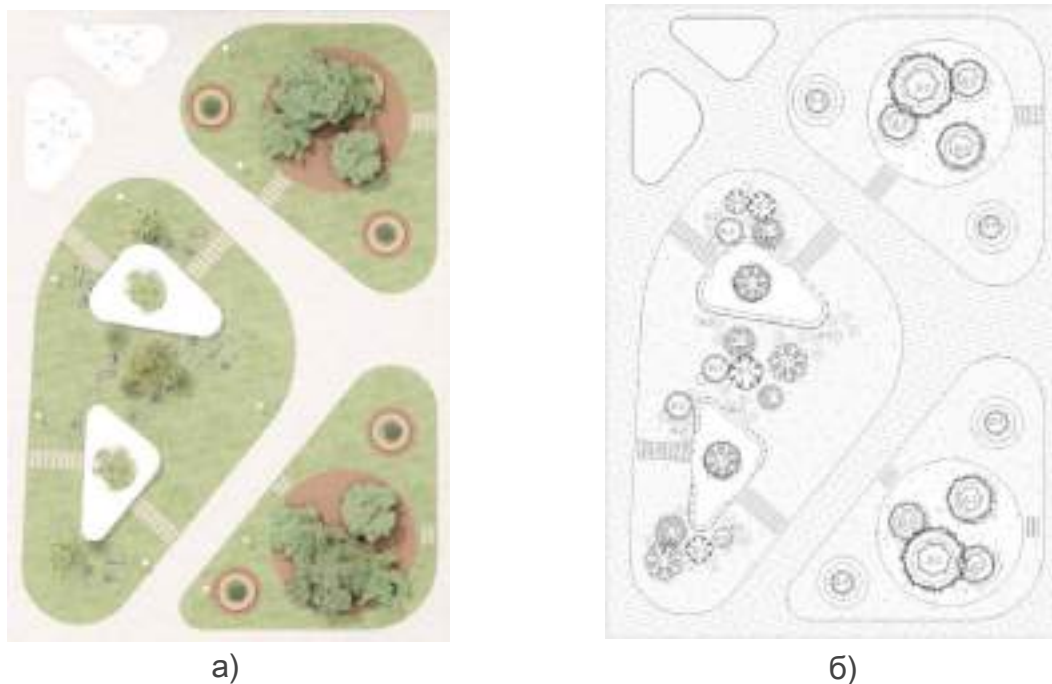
а) План обраної ділянки благоустрою; б) Дендрологічний план
